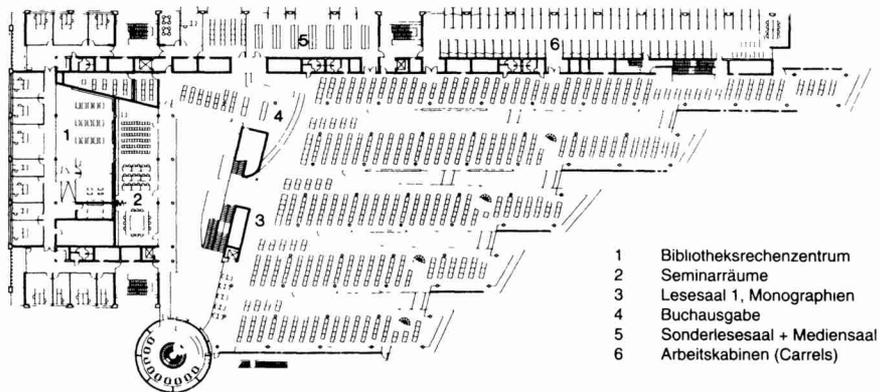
SUB-Grundriß, 1. Obergeschoß
